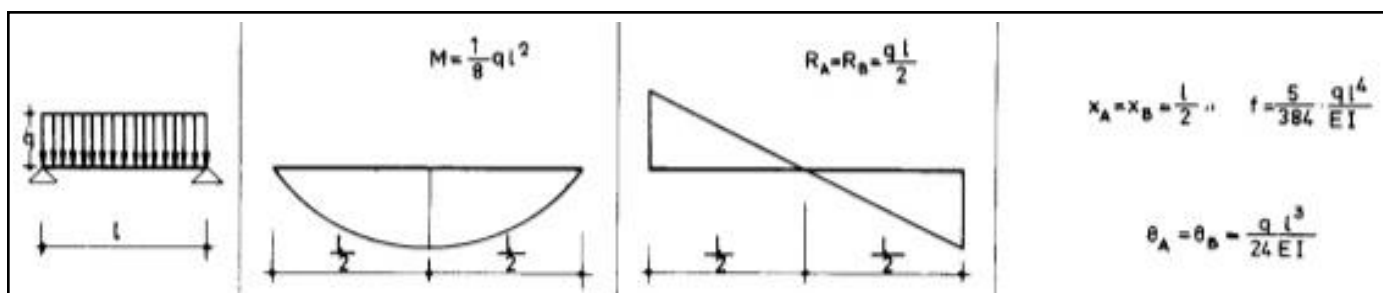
Hipótesis de cargas a vigas apoyadas.
